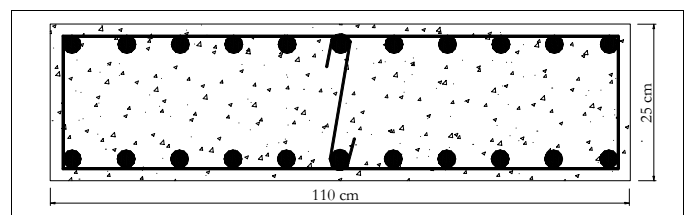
Caso 2: Arranjo das armaduras na seção transversal do pilar P1.
